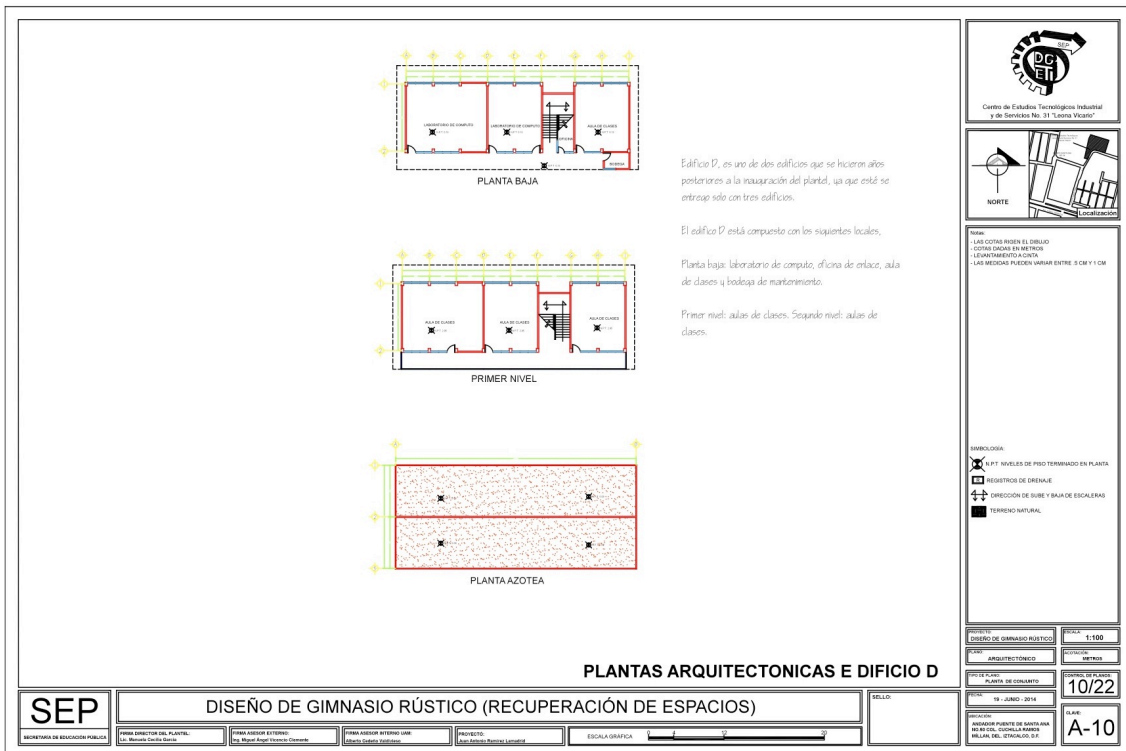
Plantas arquitectónicas edificio D, levantamiento por Juan Ramírez.
